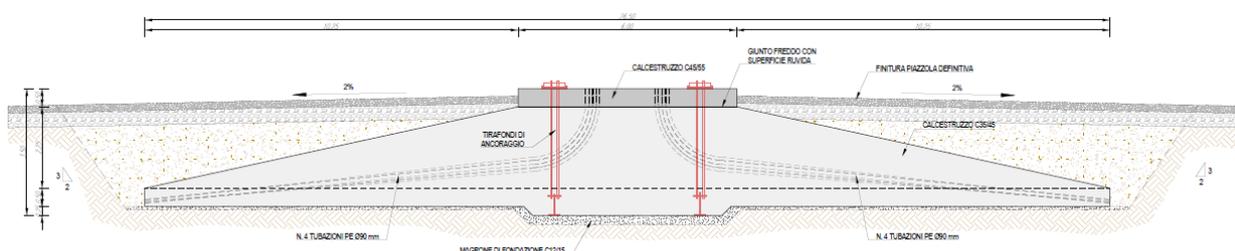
Schema tipo della fondazione dell'aerogeneratore, con plinto a tronco di cono.
